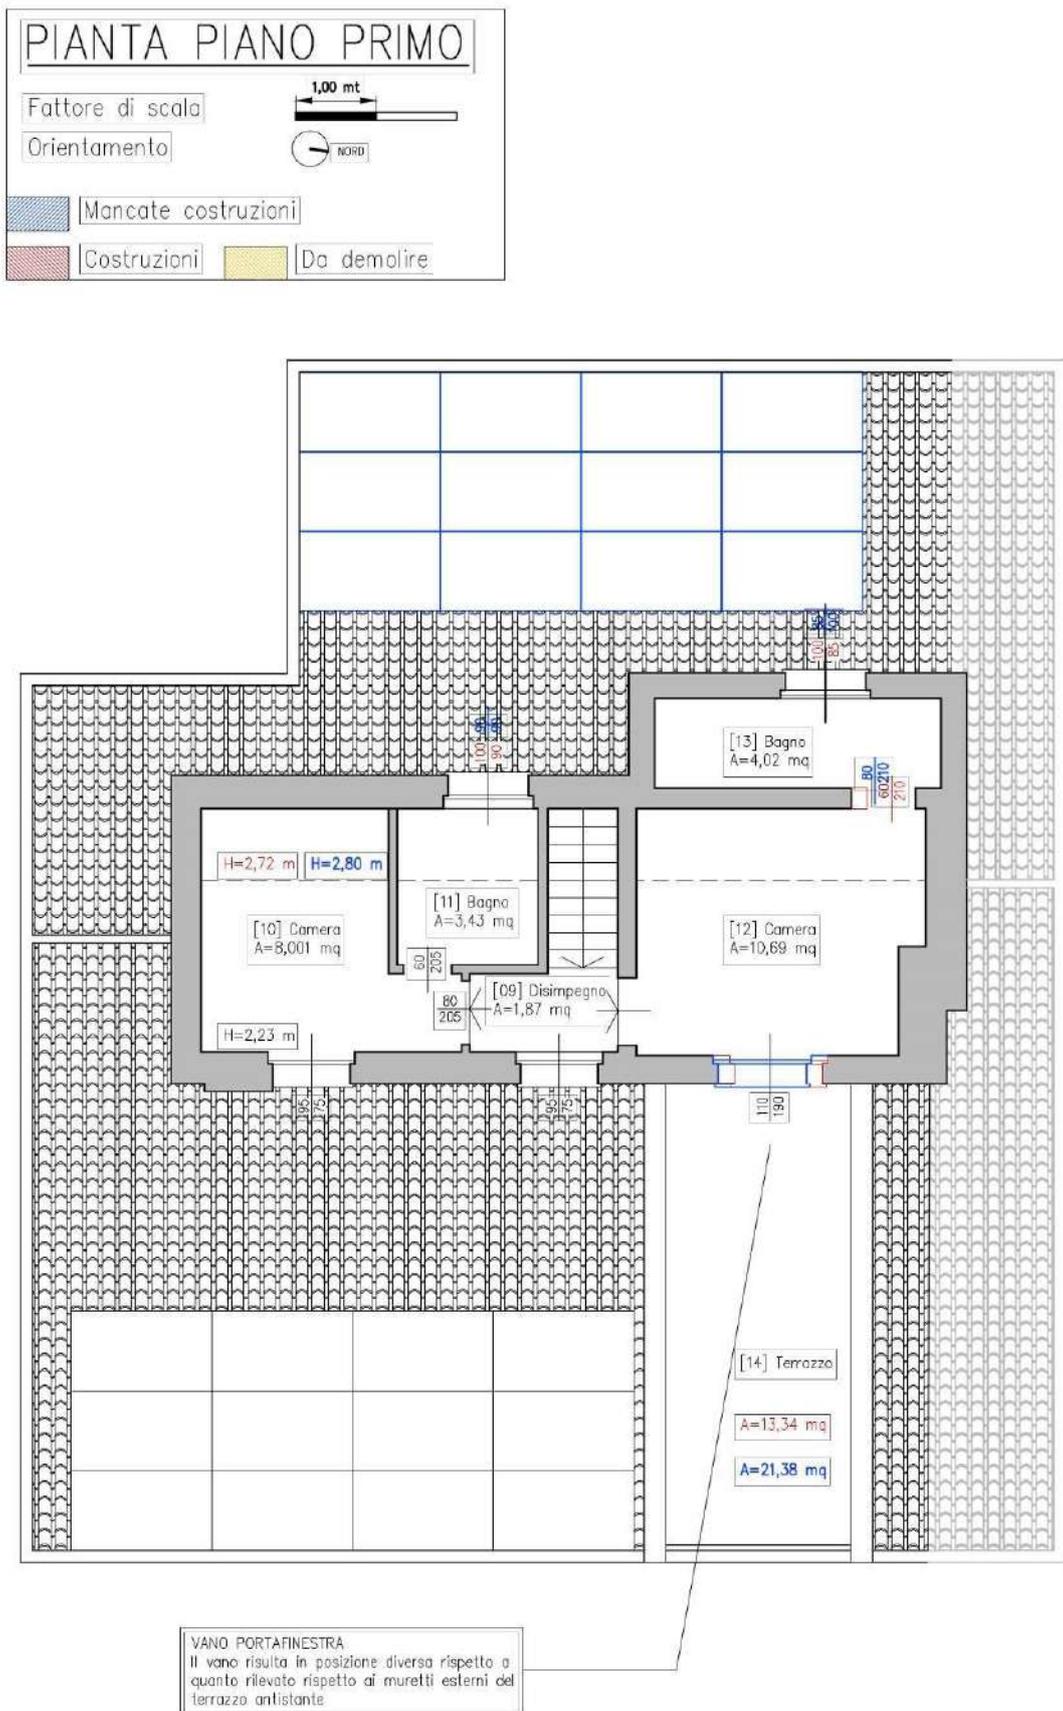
Pianta piano primo: confronto tra stato autorizzato e realizzato.
